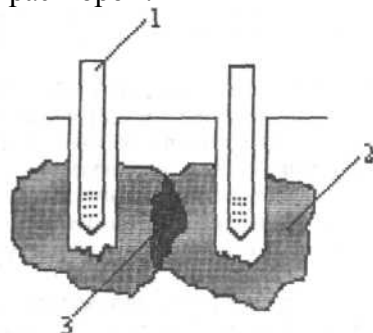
Схема закрепления грунта с помощью инъекторов 1 - инъекционная игла; 2 - зона закрепленного грунта, 3 - зона перекрытия слоев
